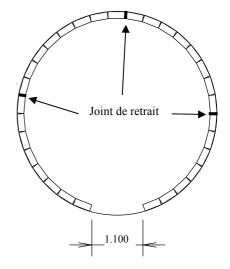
Plan planimétrique de position des parpaings
